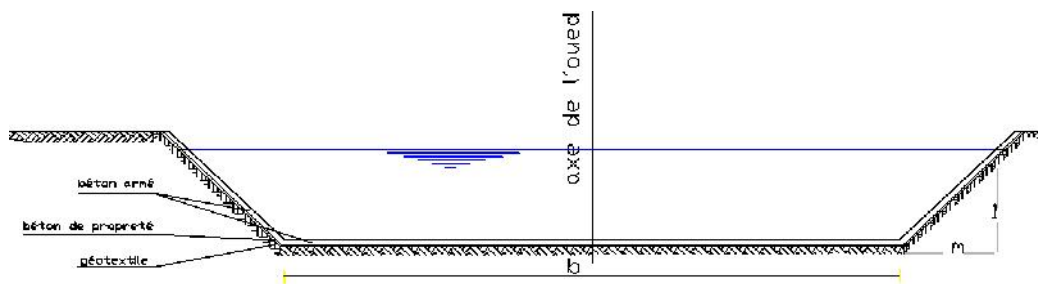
Variante N° 1 canal avec section trapézoïdale en béton armé
